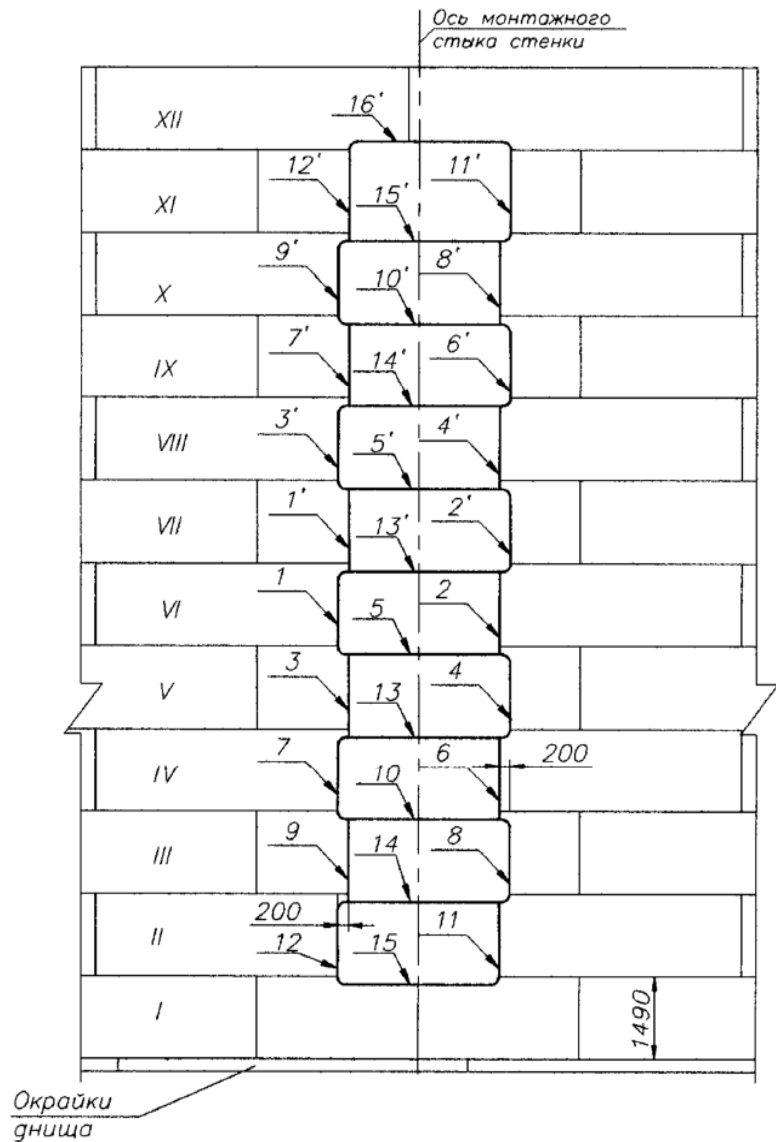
Последовательность сварки листовых вставок
